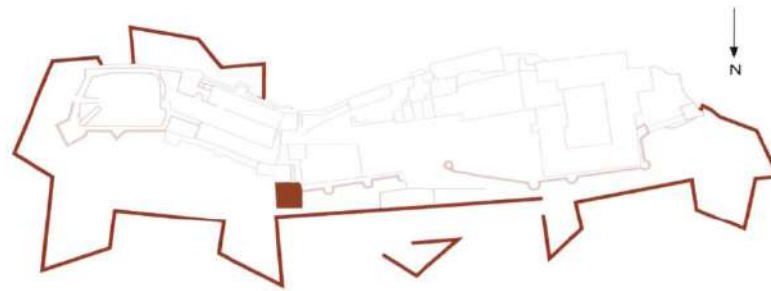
| Planta do conjunto fortificado de Palmela com os baluartes e a torre de menagem
